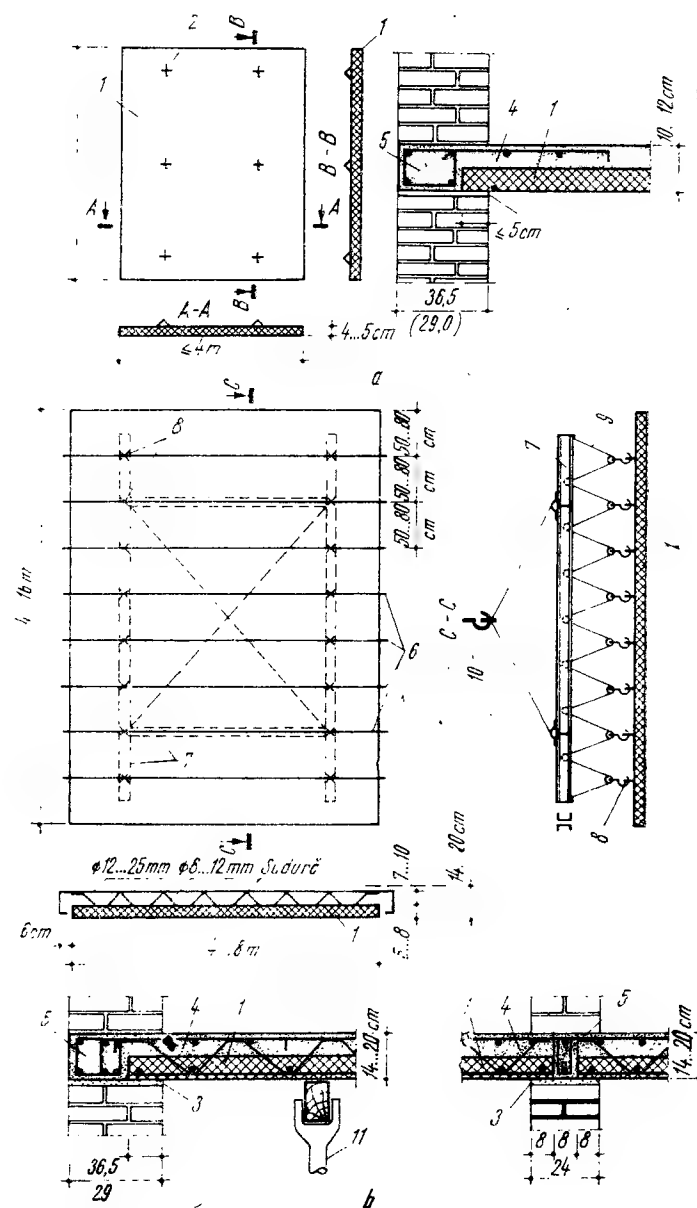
Planșee cu predale prefabricate din beton armat:
